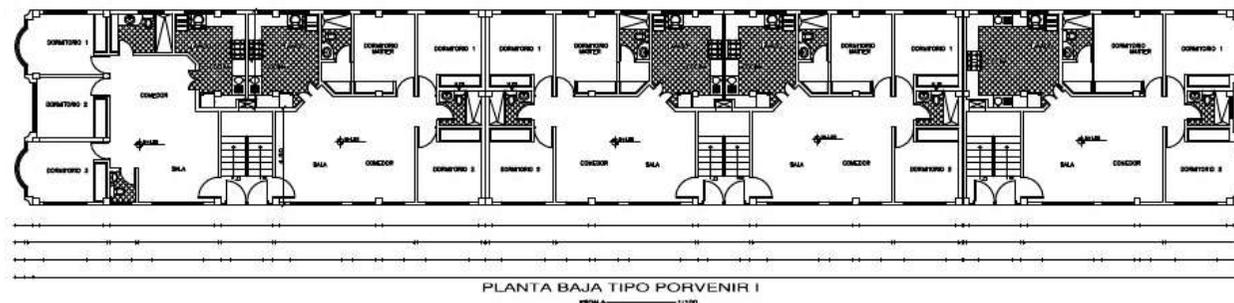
PLANTA BAJA DEL PROYECTO
